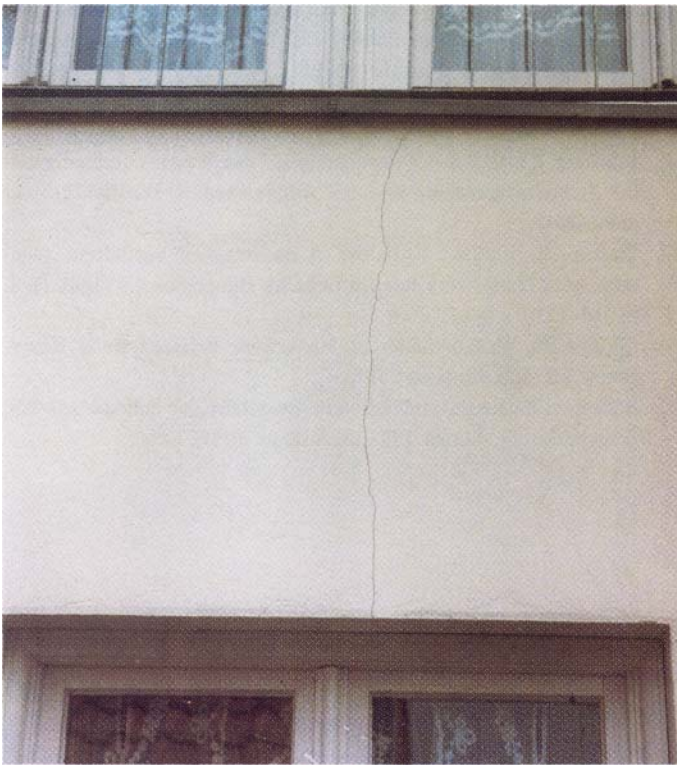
Senkrechter Riss in der verputzten Vormauerschale zweischaligen Mauerwerks (Foto H. Klaas).
